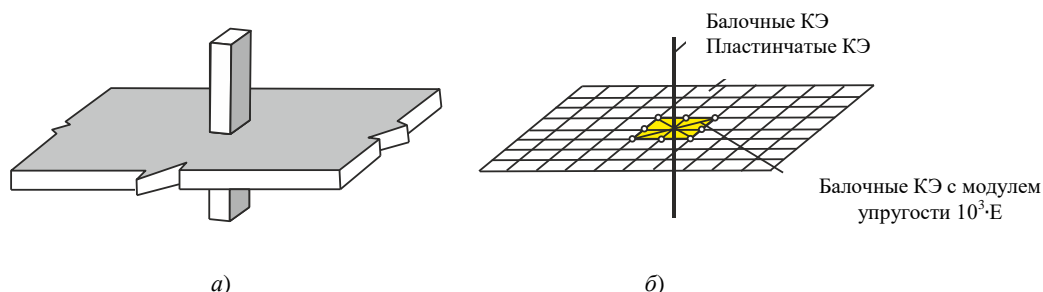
Моделирование зоны сопряжения перекрытия и колонны: а — зона сопряжения; б — расчетная схема зоны сопряжения с жесткой вставкой (рисунок авторов)
